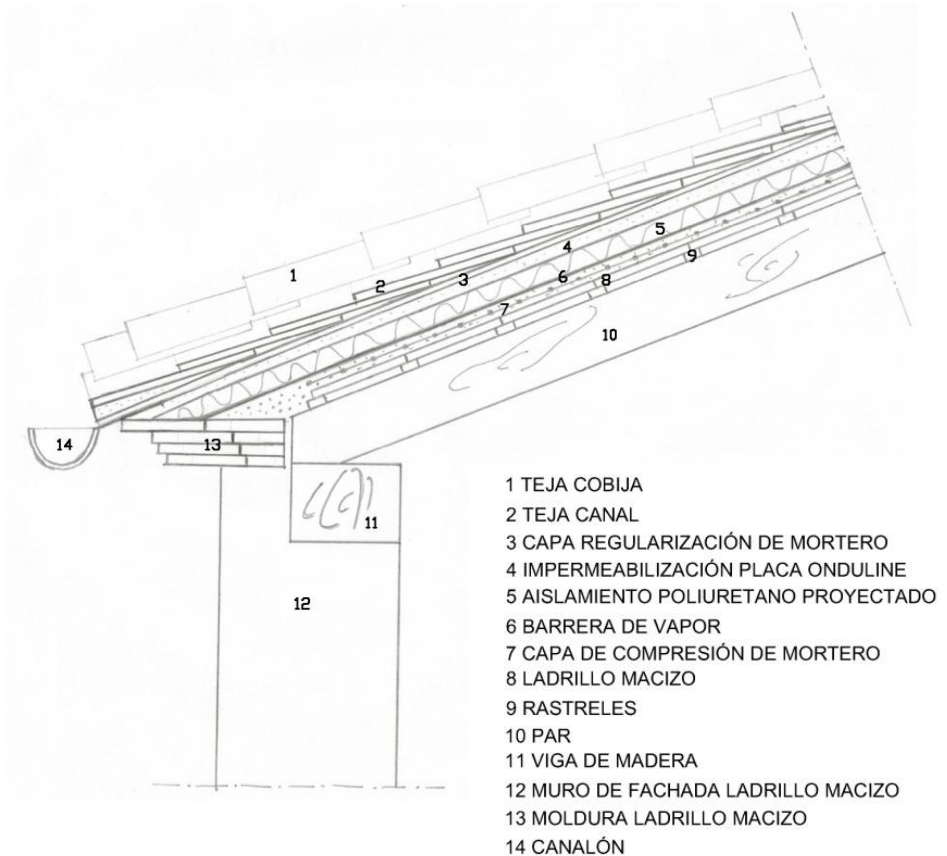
Detalle constructivo reforma cubierta. 2016. Propia.
